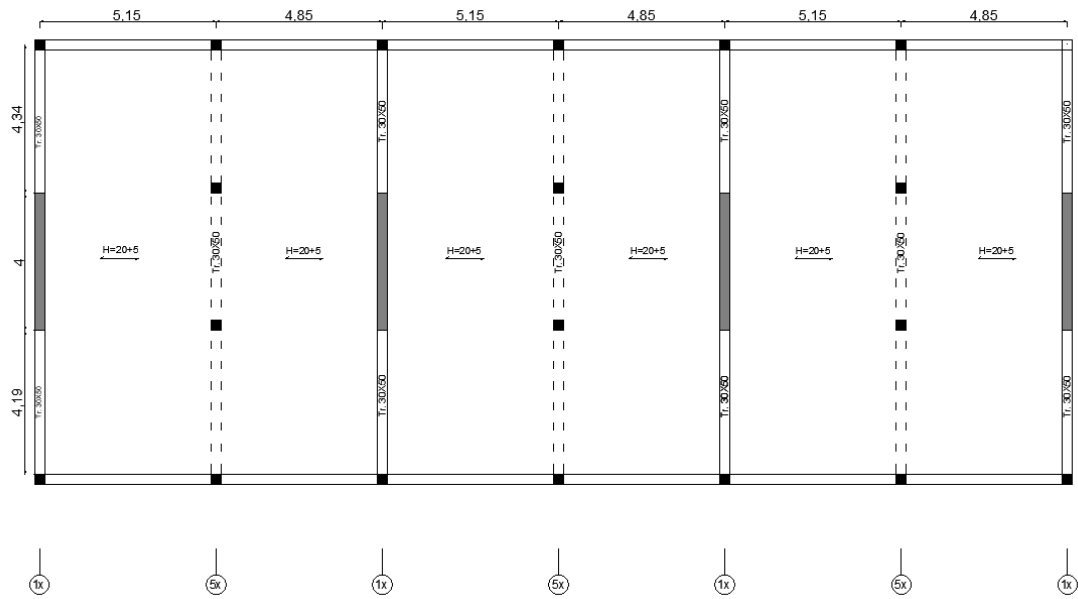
Planta estrutural com entalhe nas conexões vigas/pilares e paredes estruturais a afastadas 10m.
